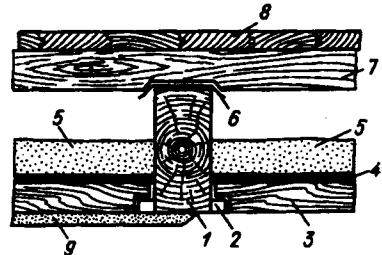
Общий вид балочного перекрытия по деревянным балкам
